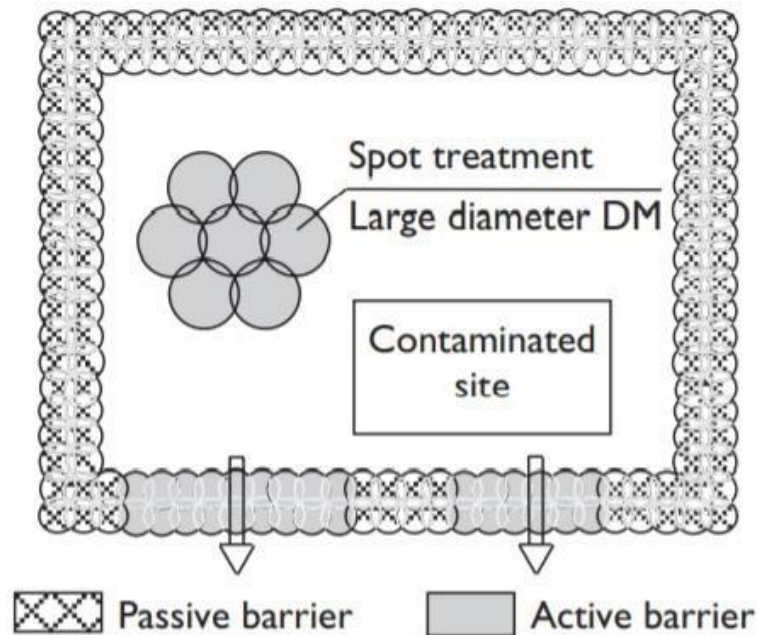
Ejemplo de aplicación de barrera en un sistema contaminado [8].
